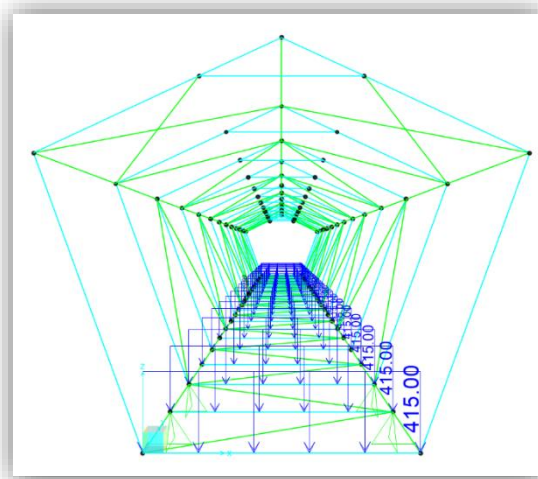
Vista en sección transversal de la estructura con carga viva (LIVE).
